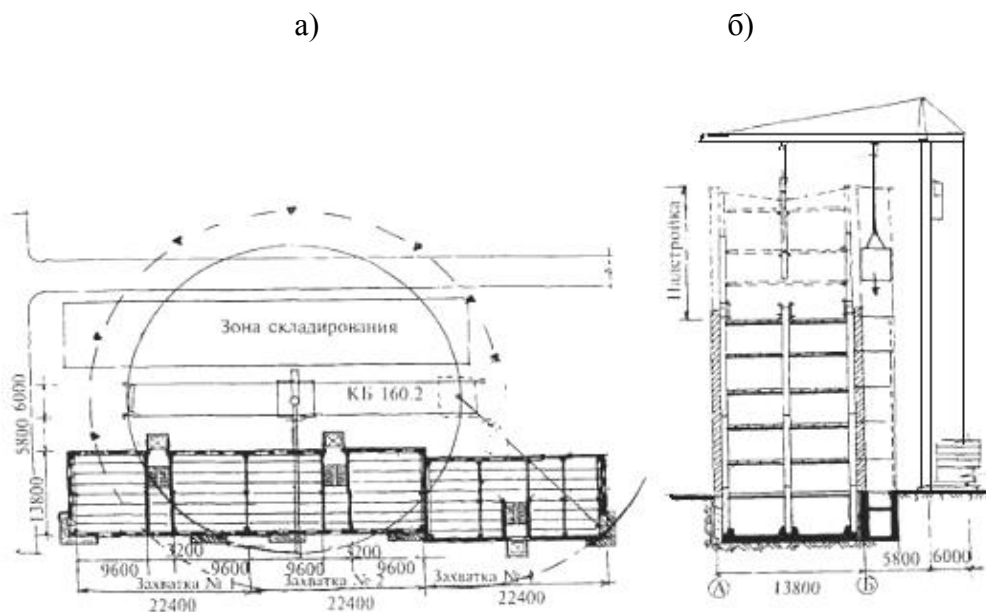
Технологическая схема реконструкции 5-этажного жилого дома с надстройкой 3-х этажей
